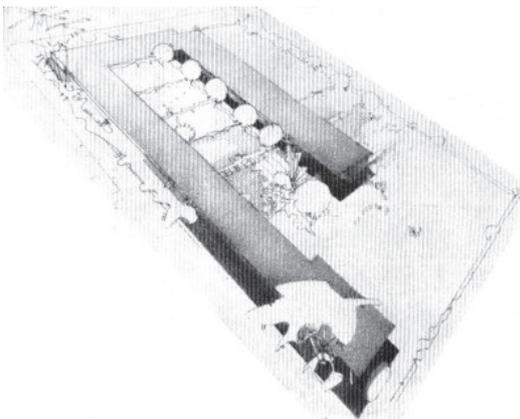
Croquis e planta para grupos escolares na América Central.
